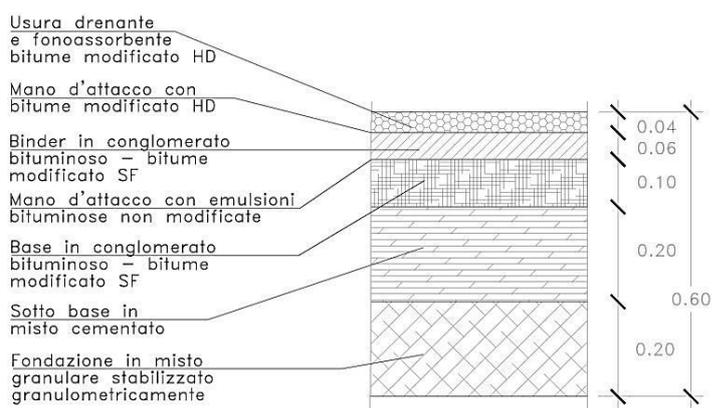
Variante di Longarone – Pavimentazione stradale
